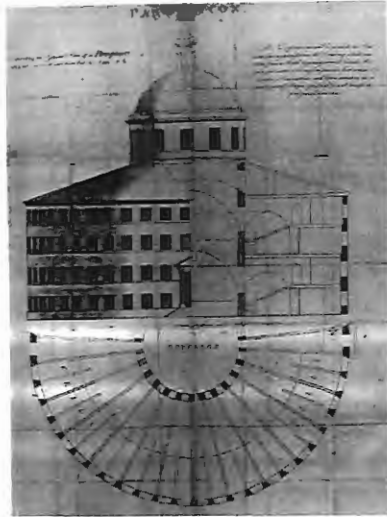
Croqui do Panóptico, 1787, corte, elevação e parte da planta.
